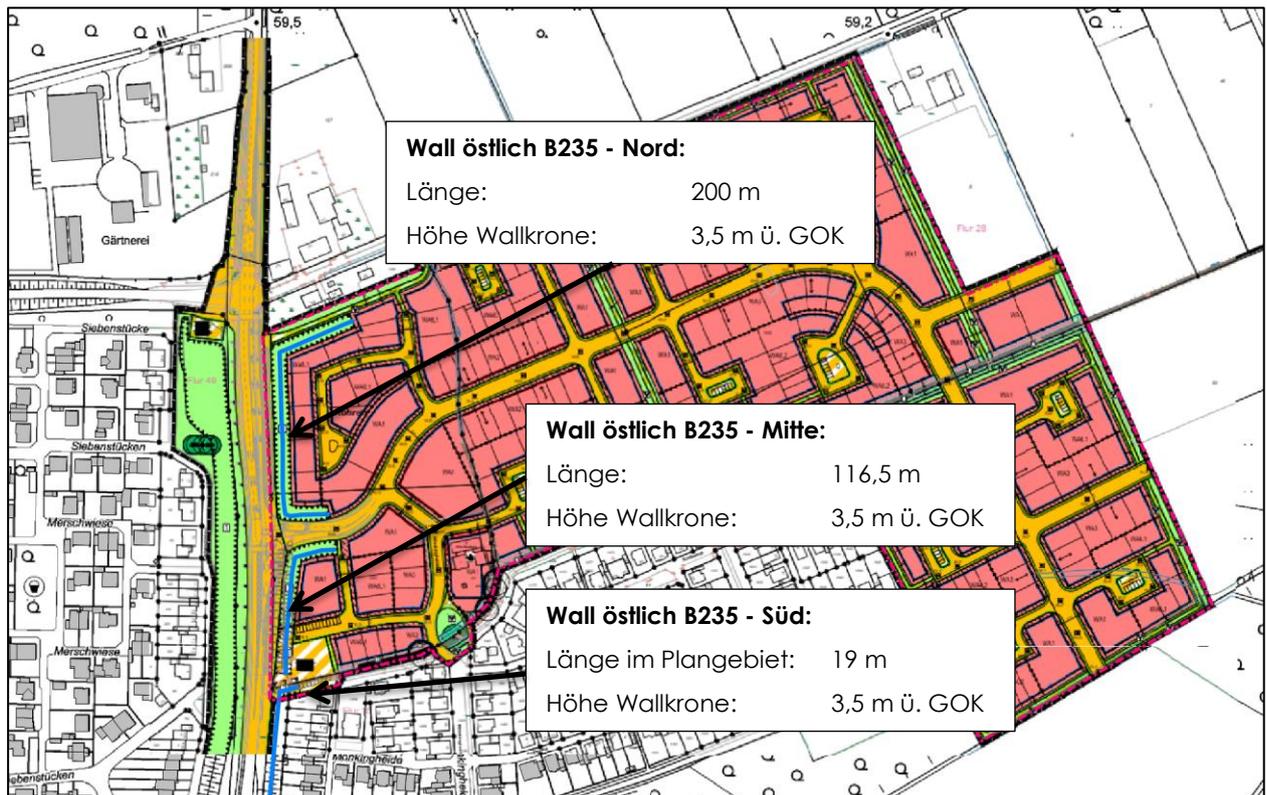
Lageplan mit Darstellung der erforderlichen Schallschutzwälle (blau = Walkkrone)
